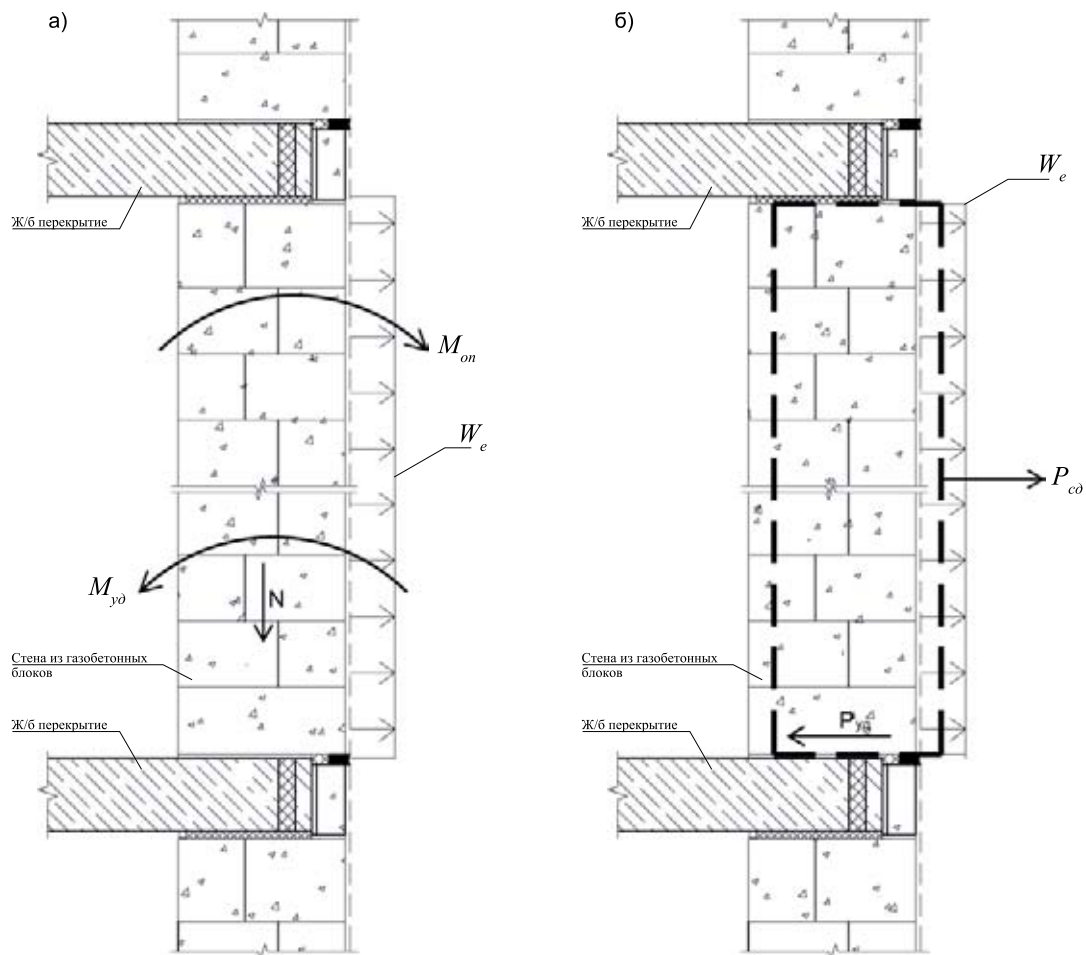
Расчетные схемы поэтажно опертых наружных стен на ветровое воздействие
